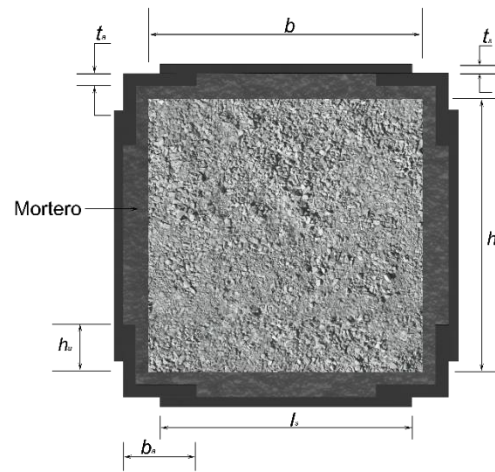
a - Sección transversal de columna encamisada con ángulos y soleras
